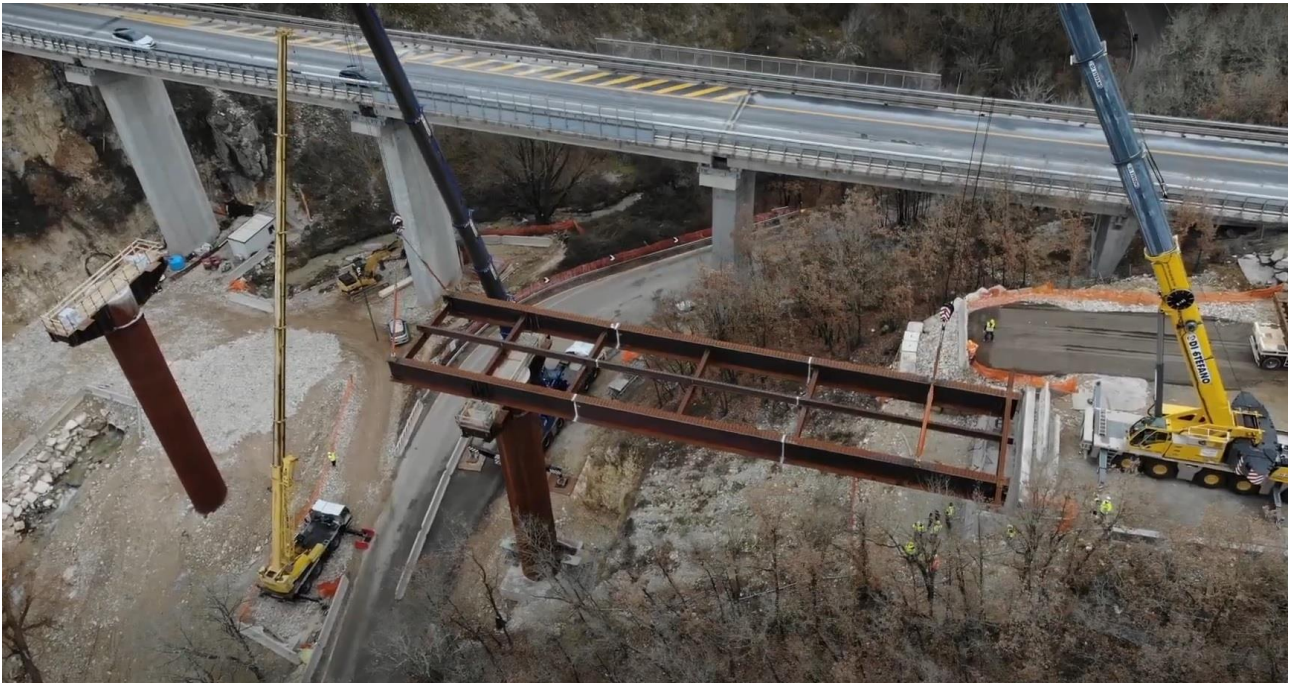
Pile completate attraverso il getto del calcestruzzo interno e inizio della fase di sollevamento impalcato
